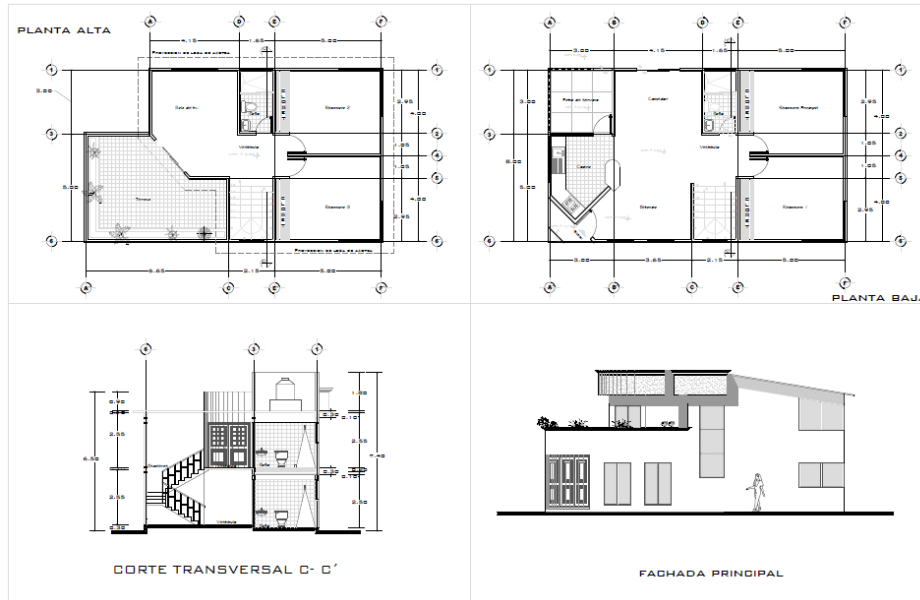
Planos arquitectónicos vivienda en Xonotla
